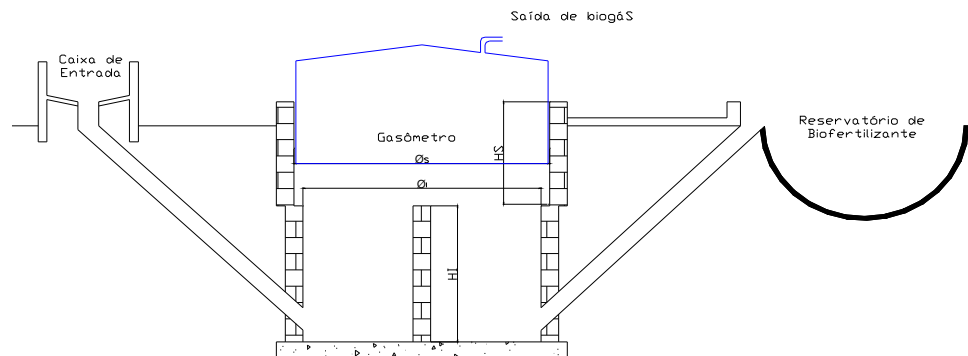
Corte longitudinal do biodigestor utilizado
